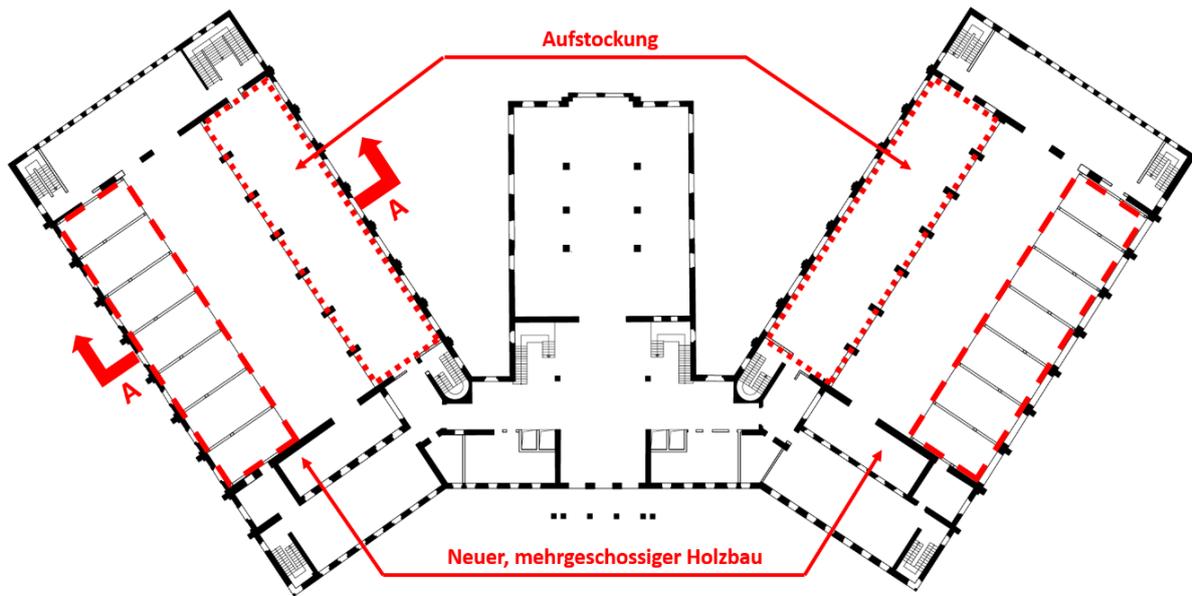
Grundriss Umbau [Triade Architekten]
